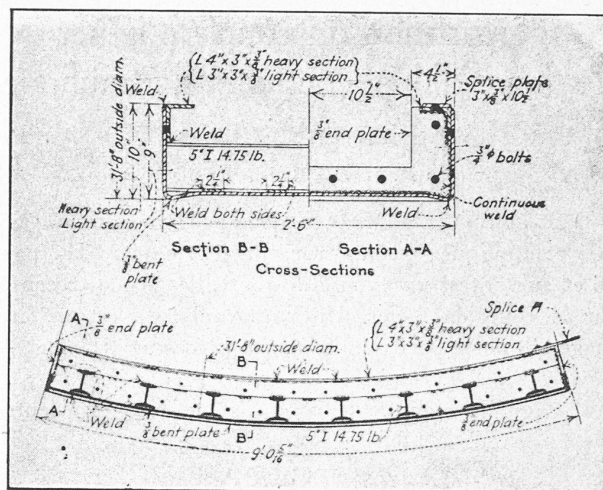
Tunnel à Détroit. — Détails des voussoirs en acier laminé. — Weld = soudure.
